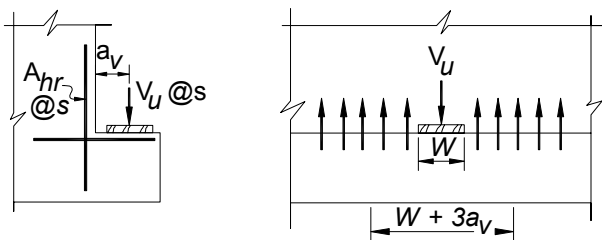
1 – Armadura de suspensión en un resalto tipo viga única
